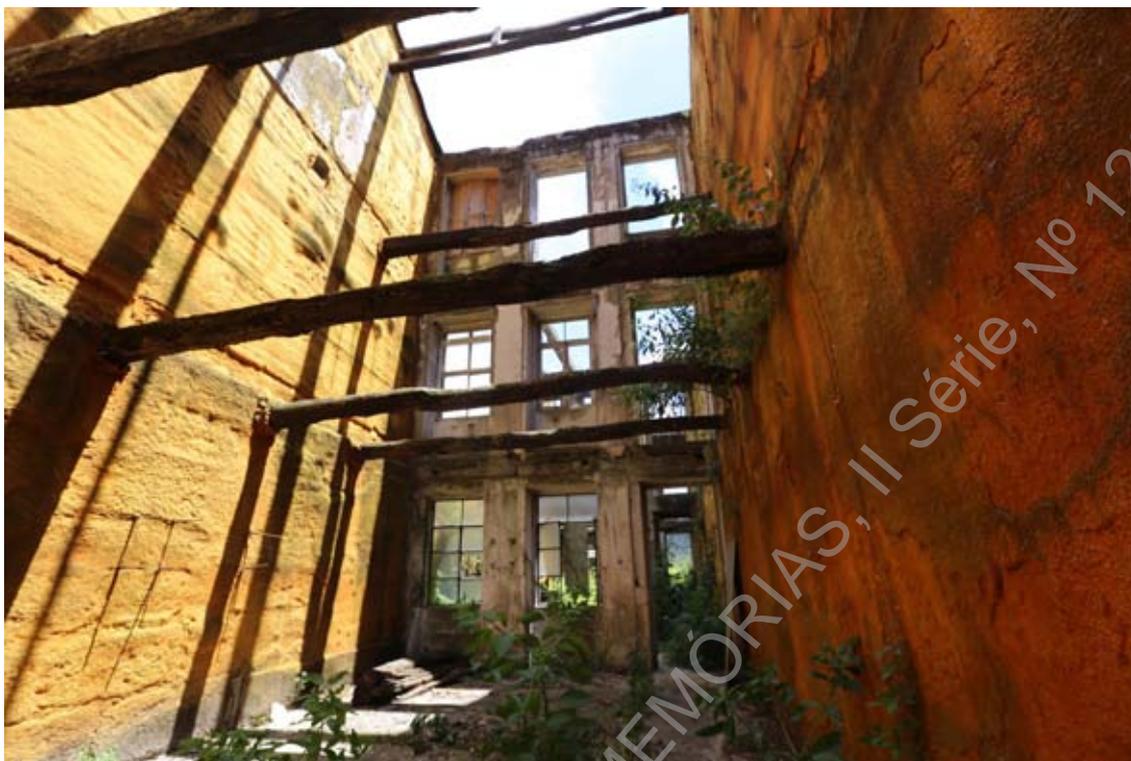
(IMG_8968) – Registo do edificado no interior do lote intervencionado.
